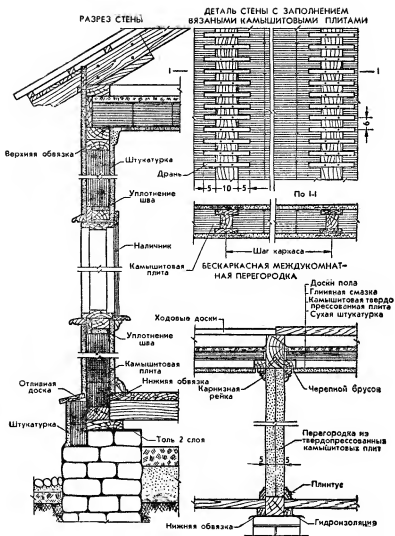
Стены, перегородки и перекрытия с применением камышовых плит,
